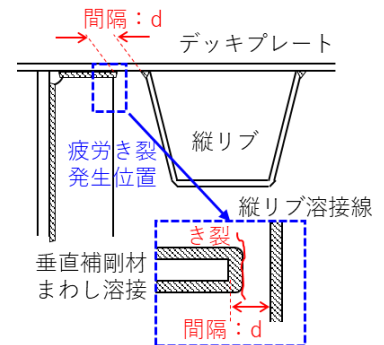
デッキプレートと垂直補剛材の溶接部
